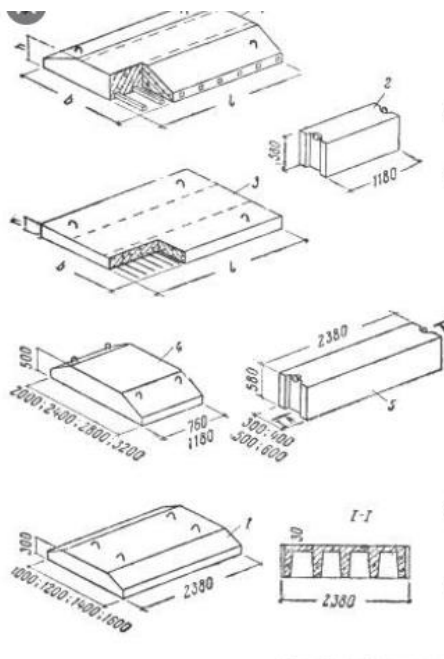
Сборные железобетонные фундаментные подушки и бетонные блоки
